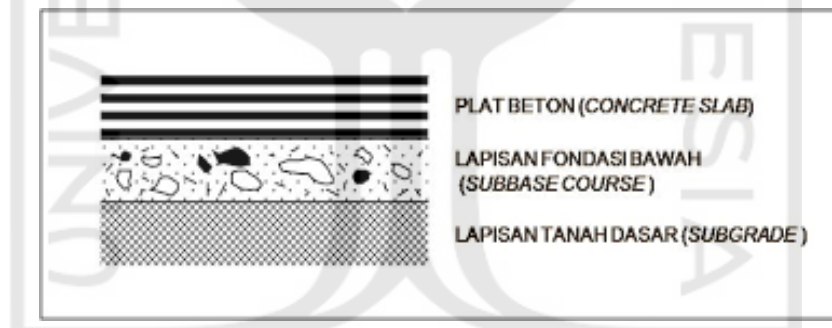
Tipikal Struktur Perkerasan Beton Semen
